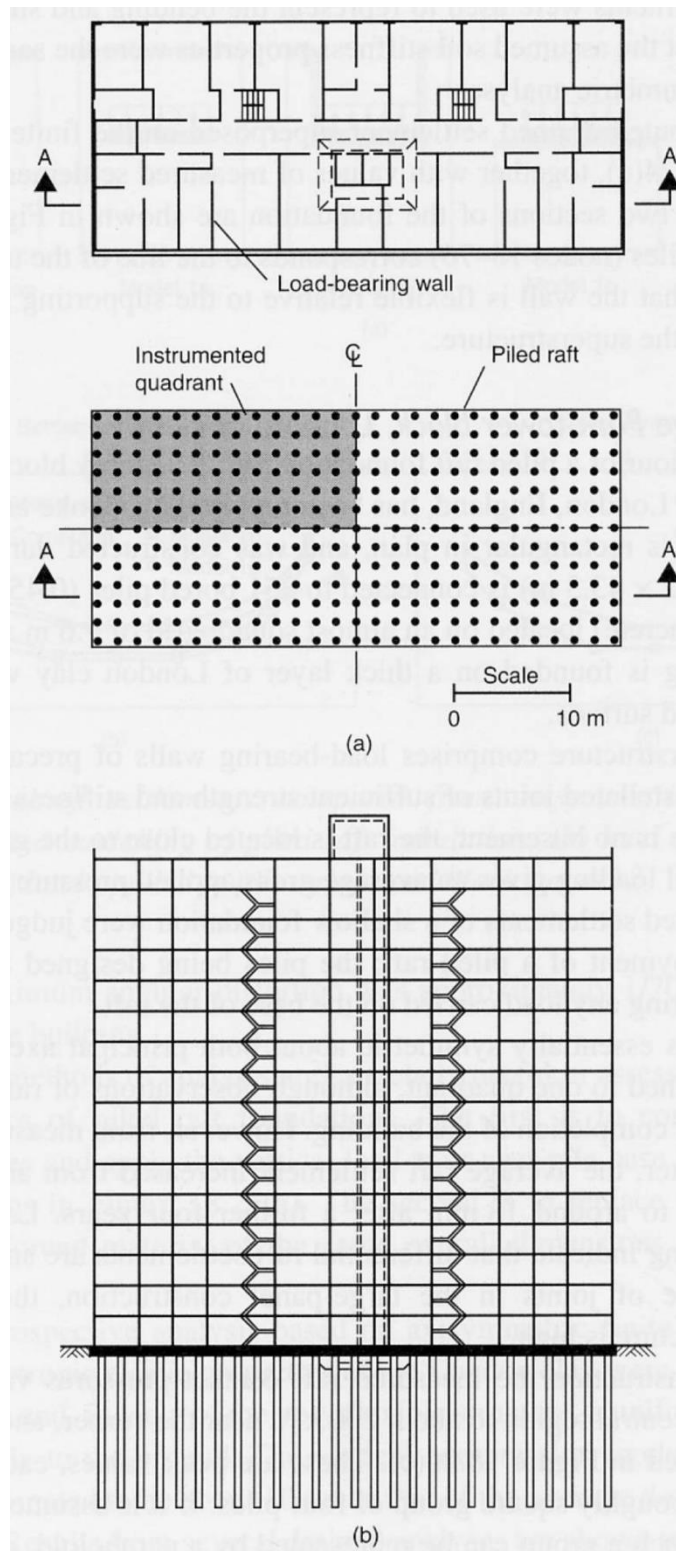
Stonebridge Tower nach Hemsley (2000)
